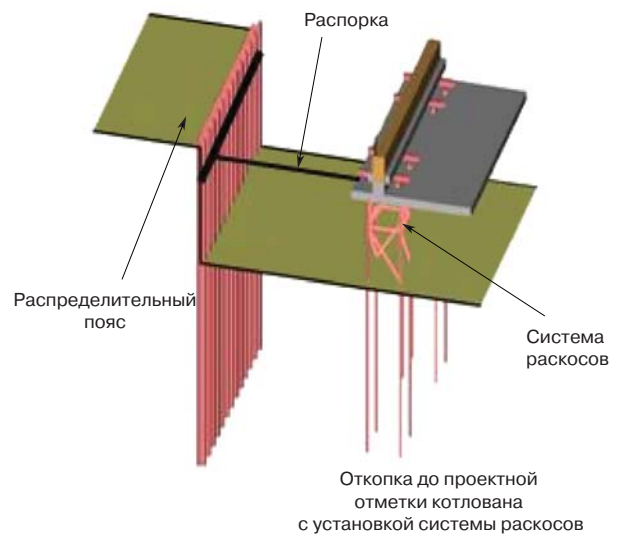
Схема откопки котлована до проектной отметки с установкой системы раскосов
